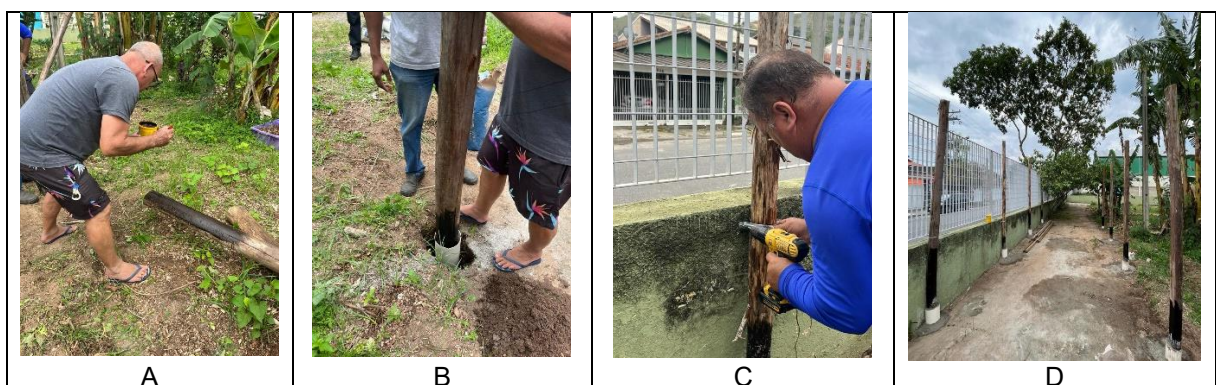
Construção da estrutura do viveiro (A: impermeabilização da parte inferior do madeiramento; B: fixação dos pontaletes no solo; C: imobilização das madeiras no muro; D: pilares já fixados no chão) (fonte: do autor, 2023).
